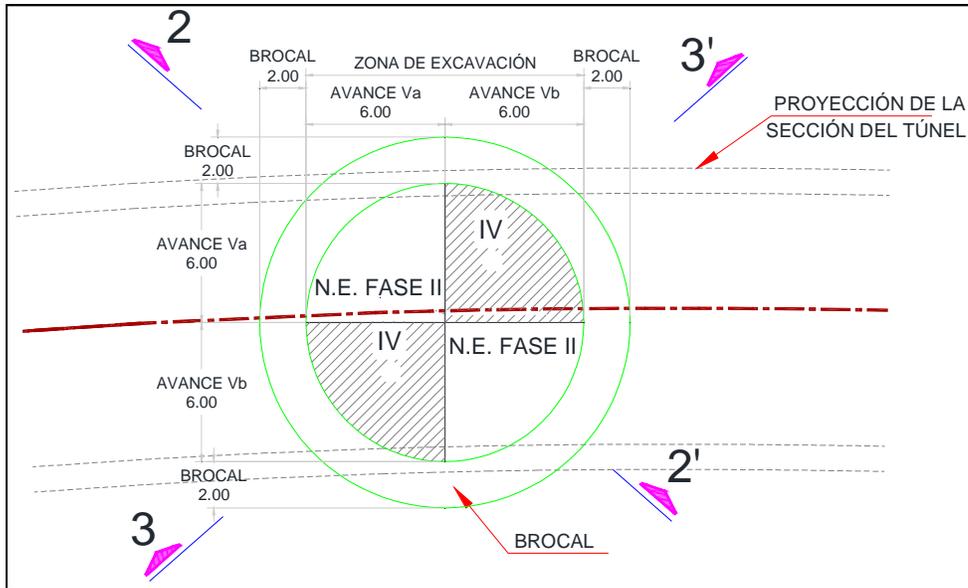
Vista en planta del avance de excavación para la etapa II
